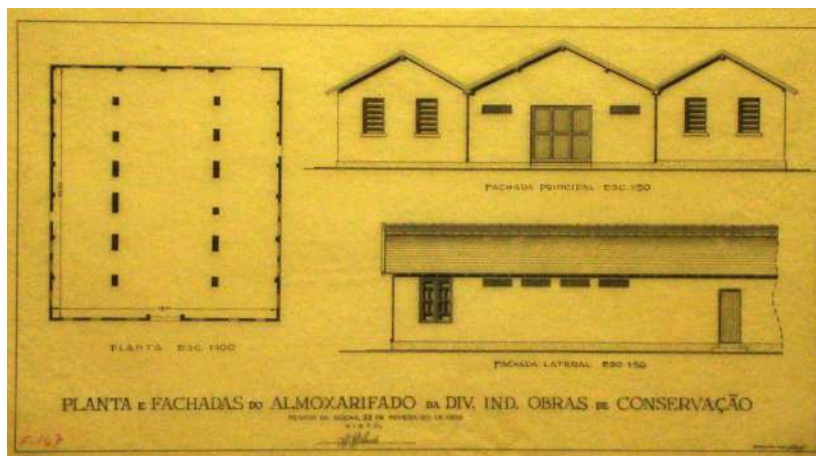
planta e fachadas do almoxarifado de apoio (acervo Museu Osório César).
